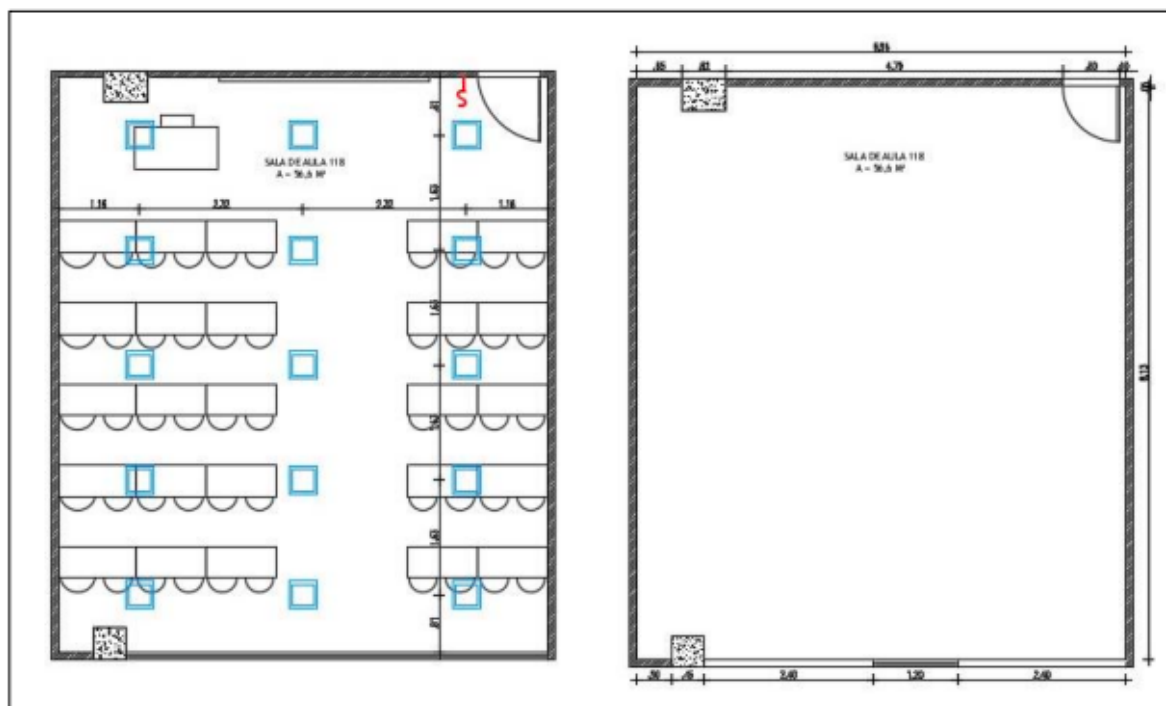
Análise do sistema de iluminação existente. Planta baixa da sala estudada.
